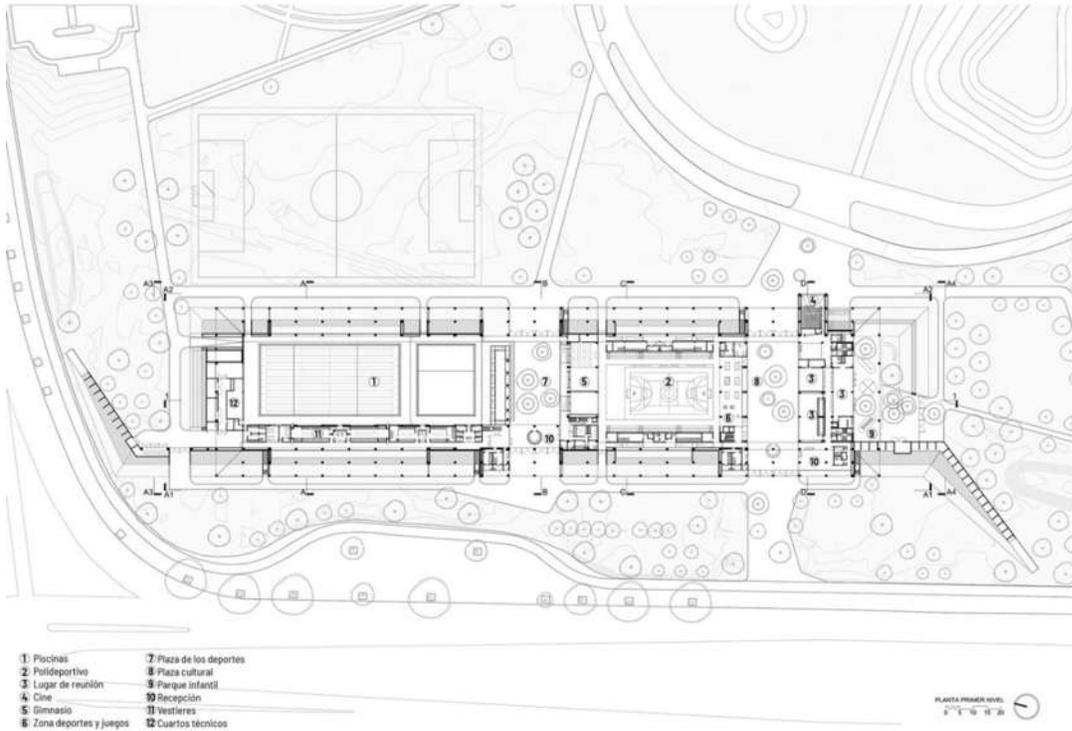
Planta arquitectónica del centro deportivo el Tunal, Fuente;
